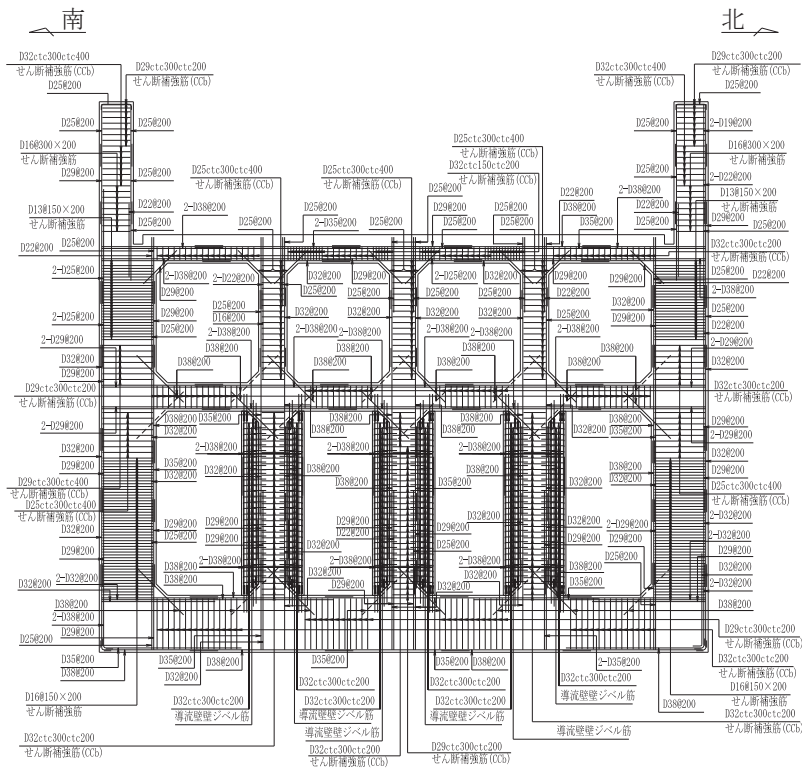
第 3 号機海水ポンプ室概略配筋図 (A-A 断面)
